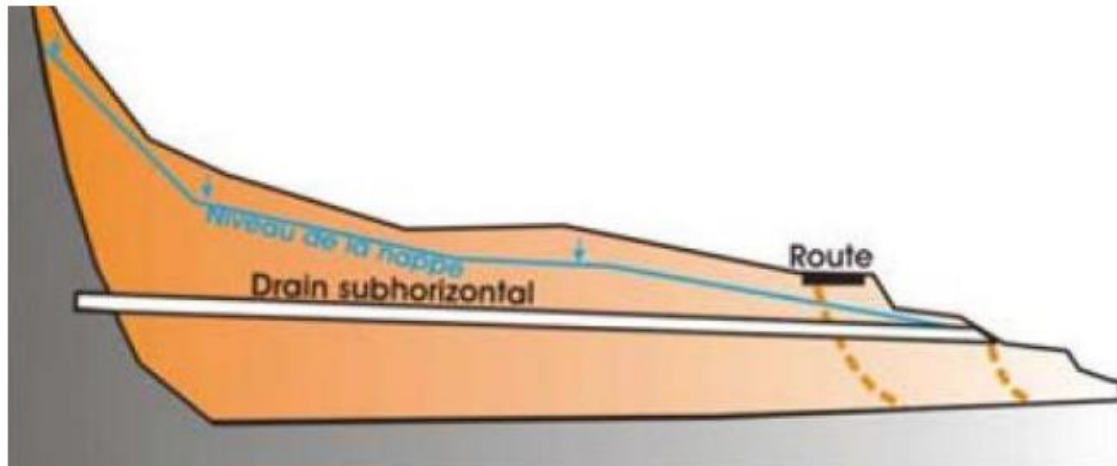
Implantation d'un drain subhorizontal. [10]
